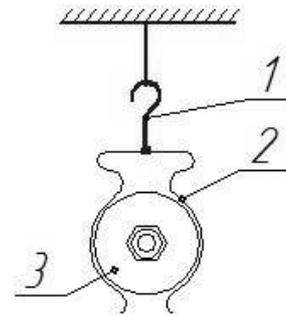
б. Вариант крепления светильника (подвес на крюк):
